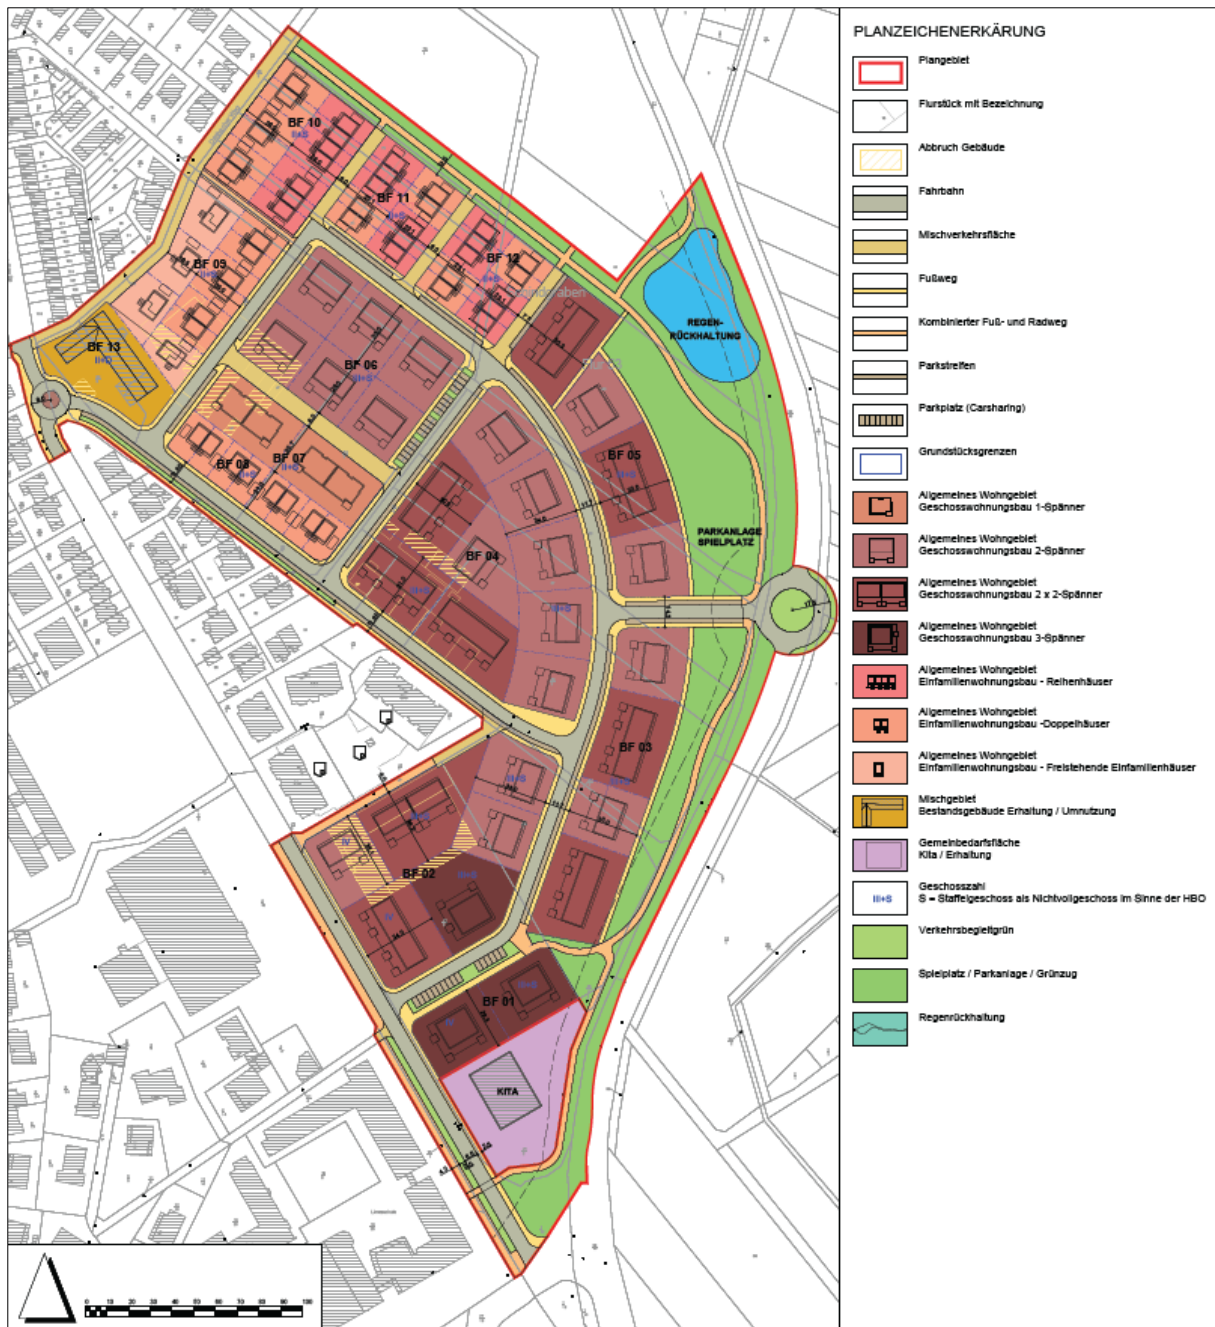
Städtebauliches Konzept Variante 1 (Stand: 29.10.2025)
